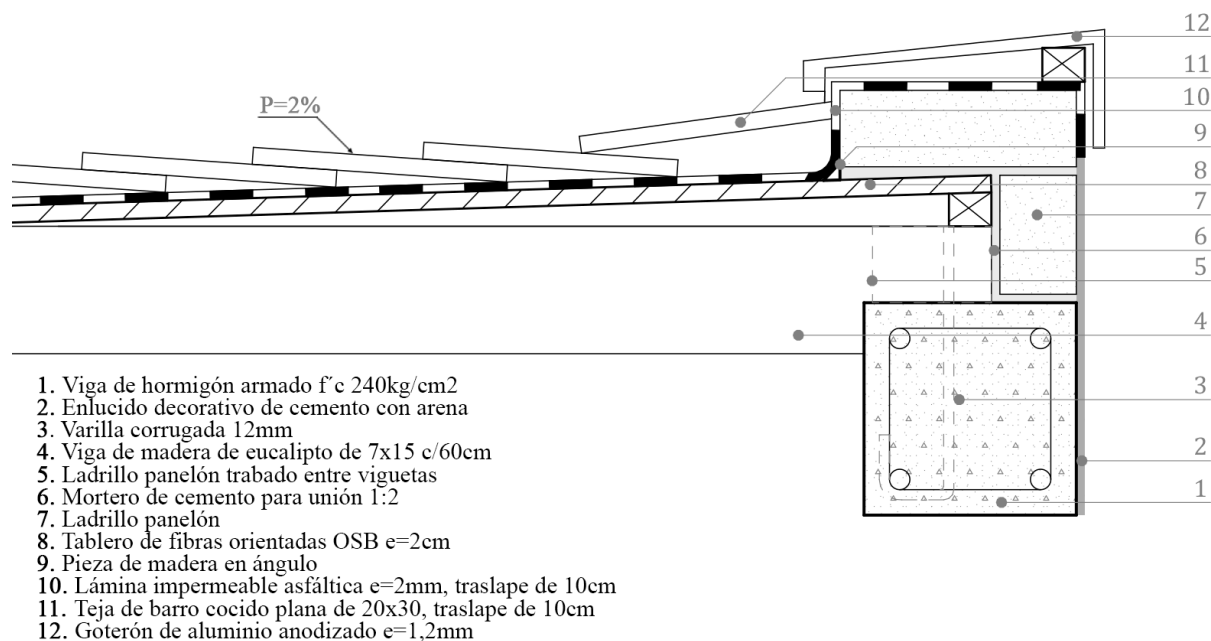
Detalle de impermeabilización de cubierta, considerada para la propuesta de diseño.
